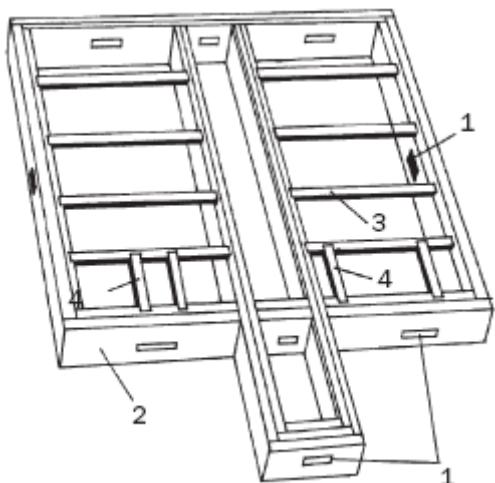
Вентиляция фундамента: 1 – продухи; 2 – фундамент; 3 – лаги; 4 – дополнительные балки фиксации
